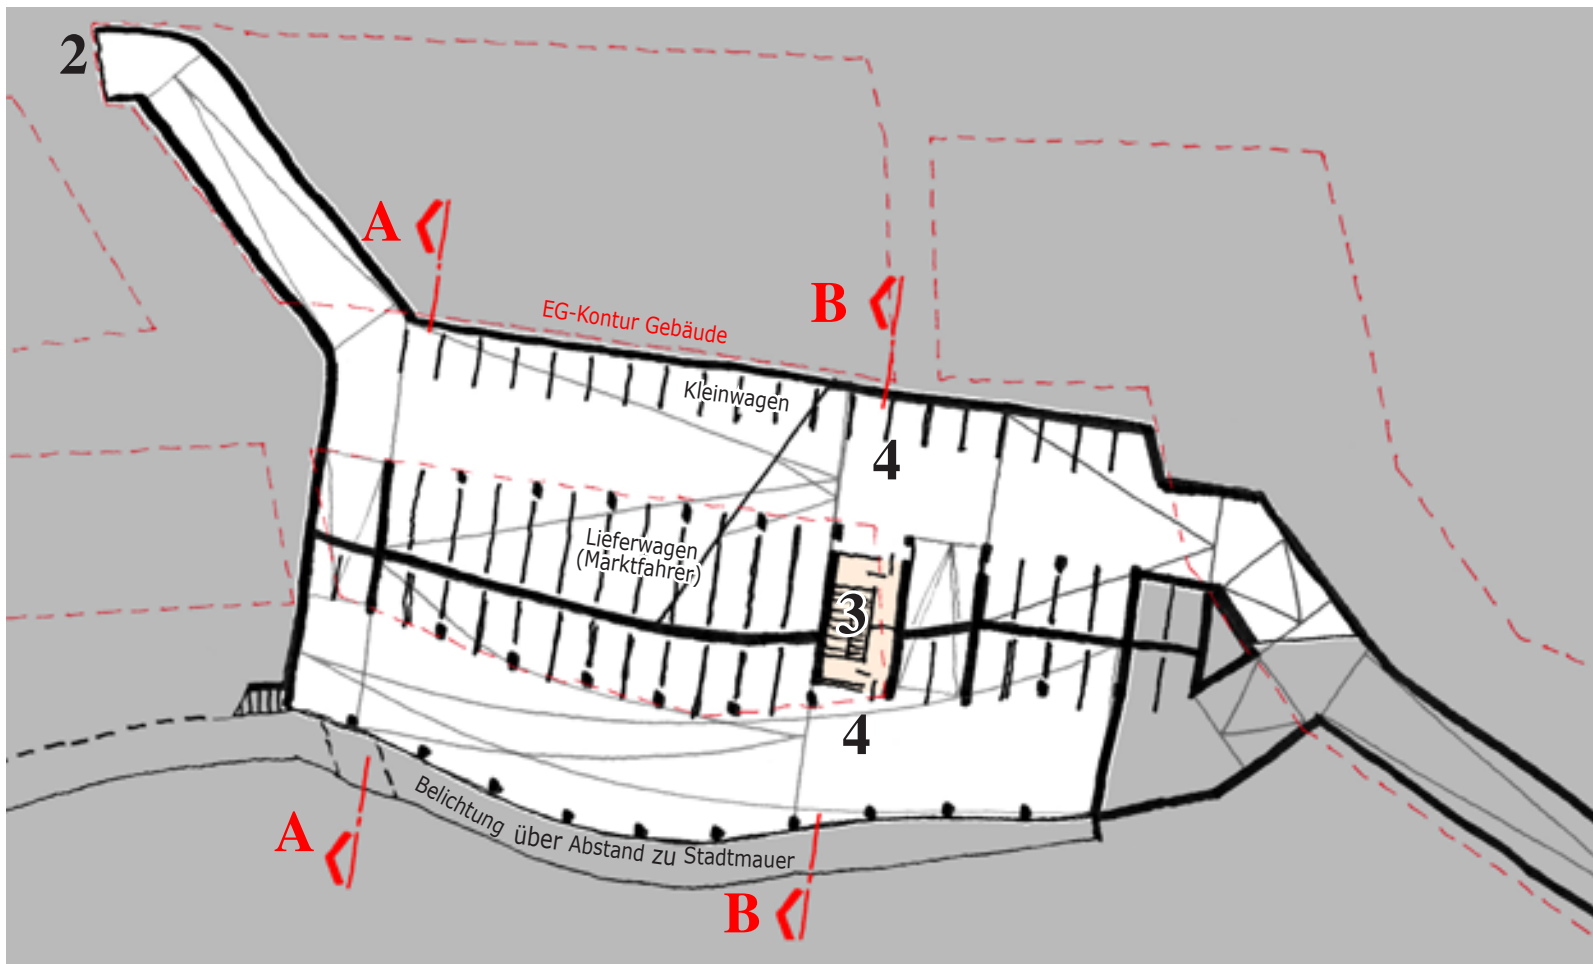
Tiefgarage Grundriss UG2; M1:500
